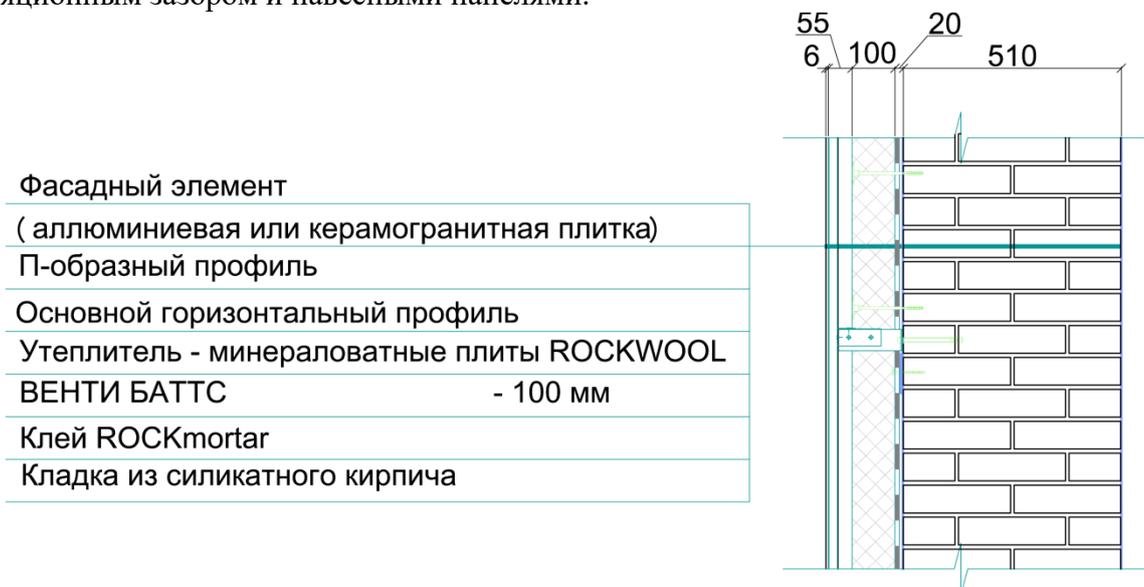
Фрагмент навесного вентилируемого фасада дома.
